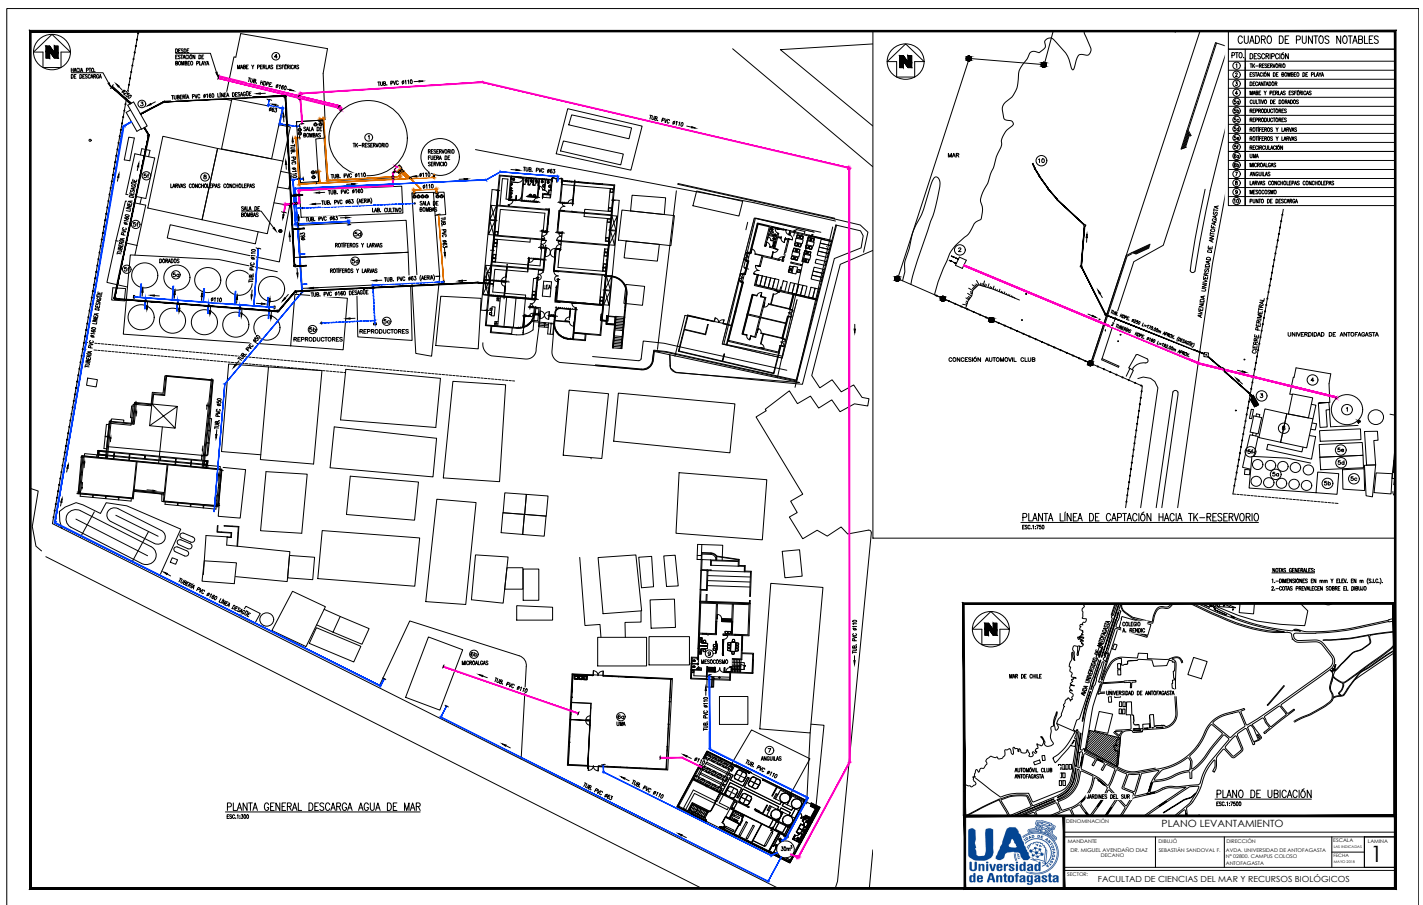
Planta general FACIMAR, captación, distribución y descarga
